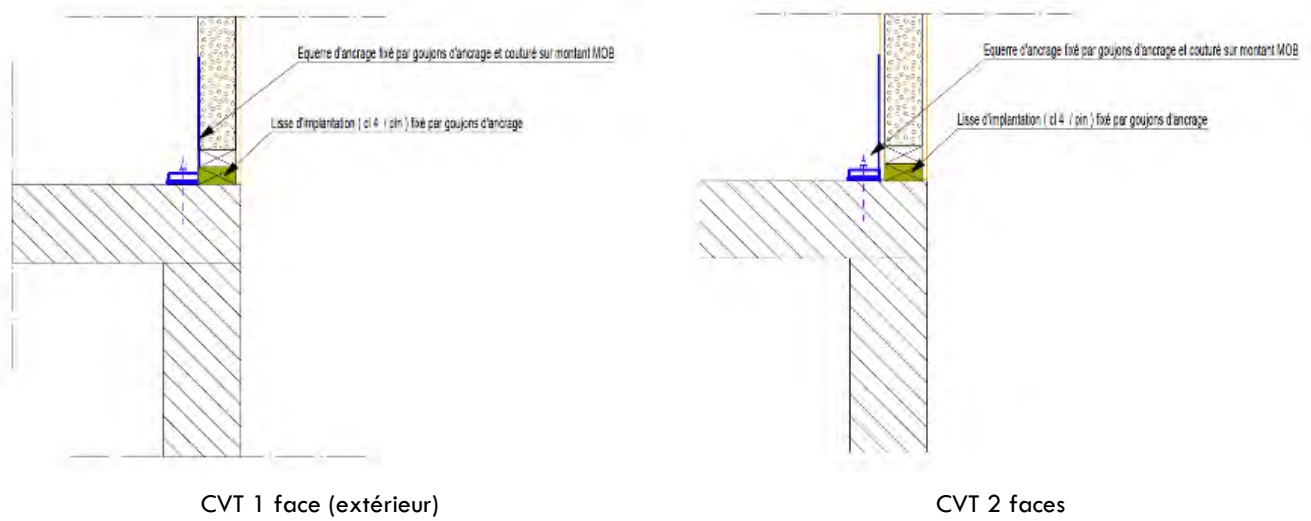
COB – Coupe de principe d'ancrage (traction) des éléments préfabriqués à la dalle
